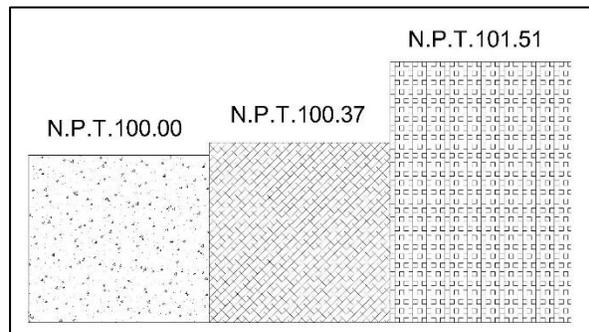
Diagrama de Niveles de Pisos al Interior de Planta Piloto.
